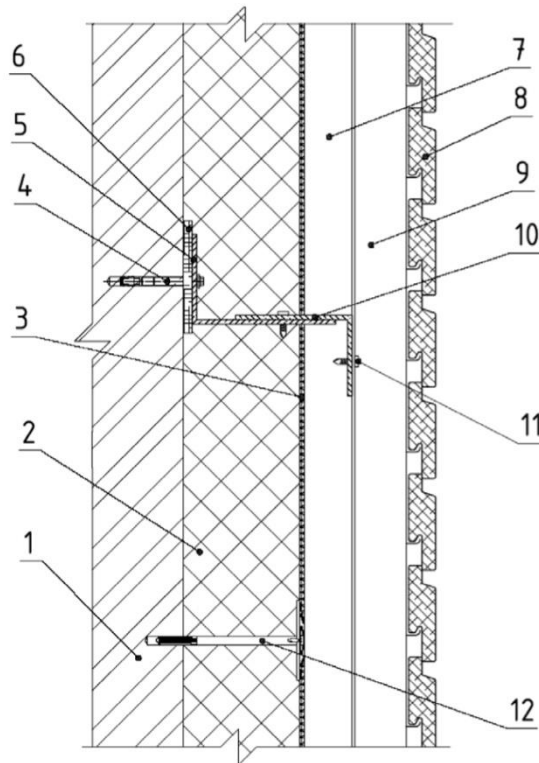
Конструктивна схема збірної фасадної системи із стояково-ригільним кріпленням зовнішнього оздоблювального захистного шару: 1 - несуча частина стіни; 2 - шар теплової ізоляції; 3 - повітрозахисна мембранна плівка; 4 - анкер; 5- кронштейн; 6 - прокладка паронітова; 7 - повітряний вентиляований прошарок; 8 - індустриальні личкувальні елементи (керамічні плити); 9 - стояк; 10 - ригель; 11 - з'єднальні елементи; 12 - елемент механічного кріплення утеплювача.
